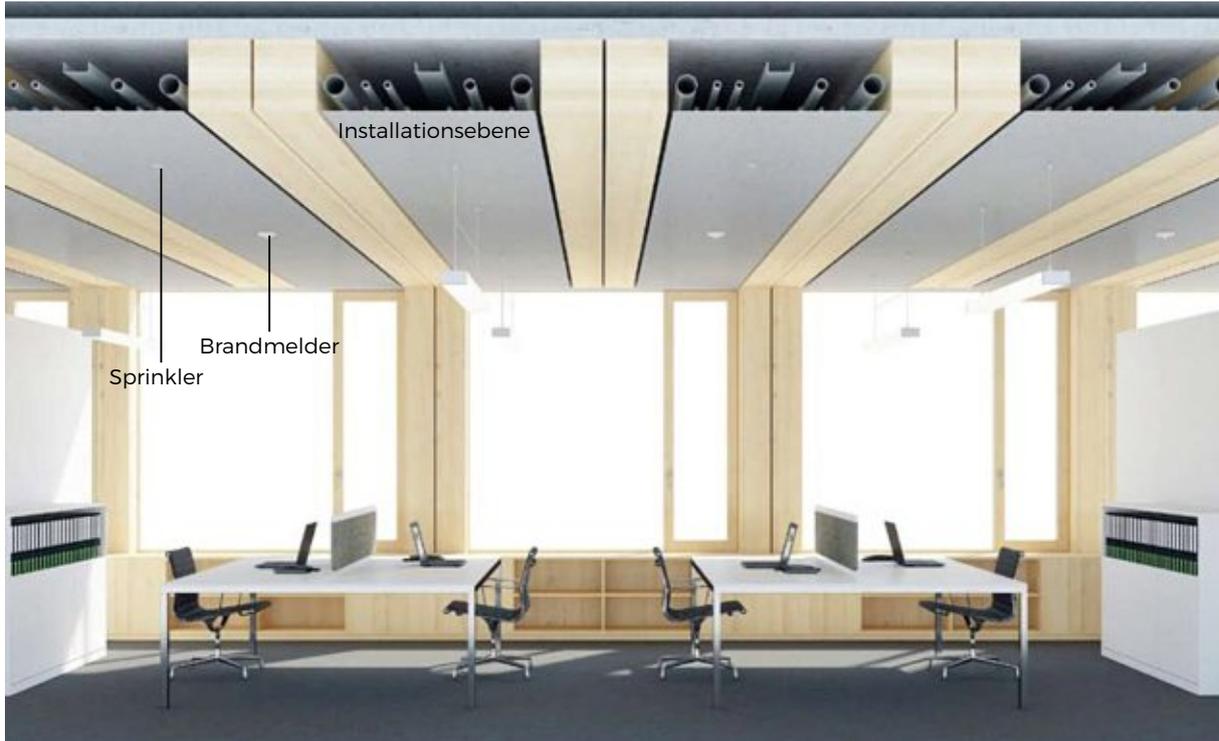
Schaubild - Schnitt durch die Installationsschicht der Deckenelemente
